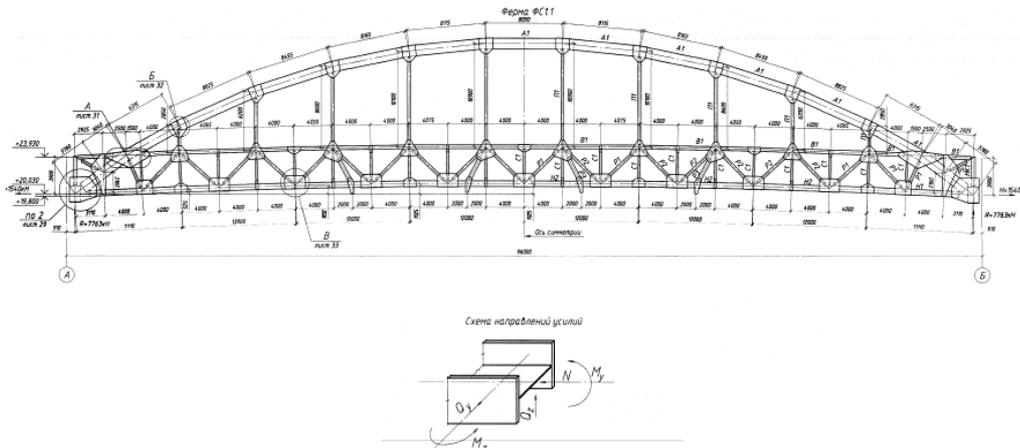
Пояса из сварных двутавров покрытия цеха
